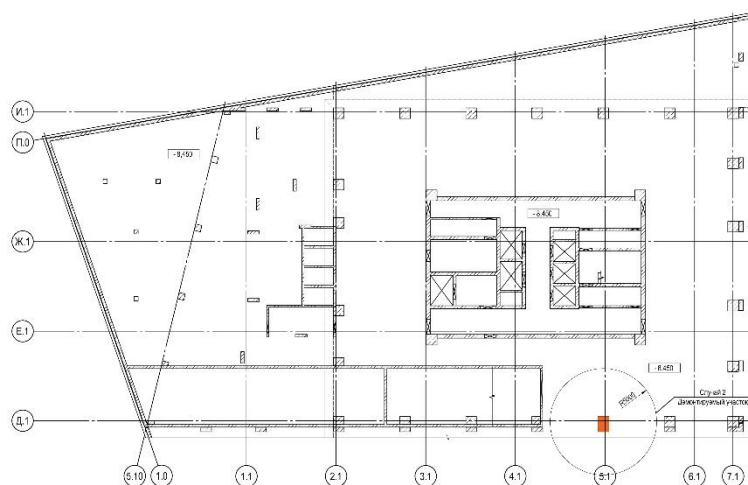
Корпус К-1. Схема аварийного случая 2
